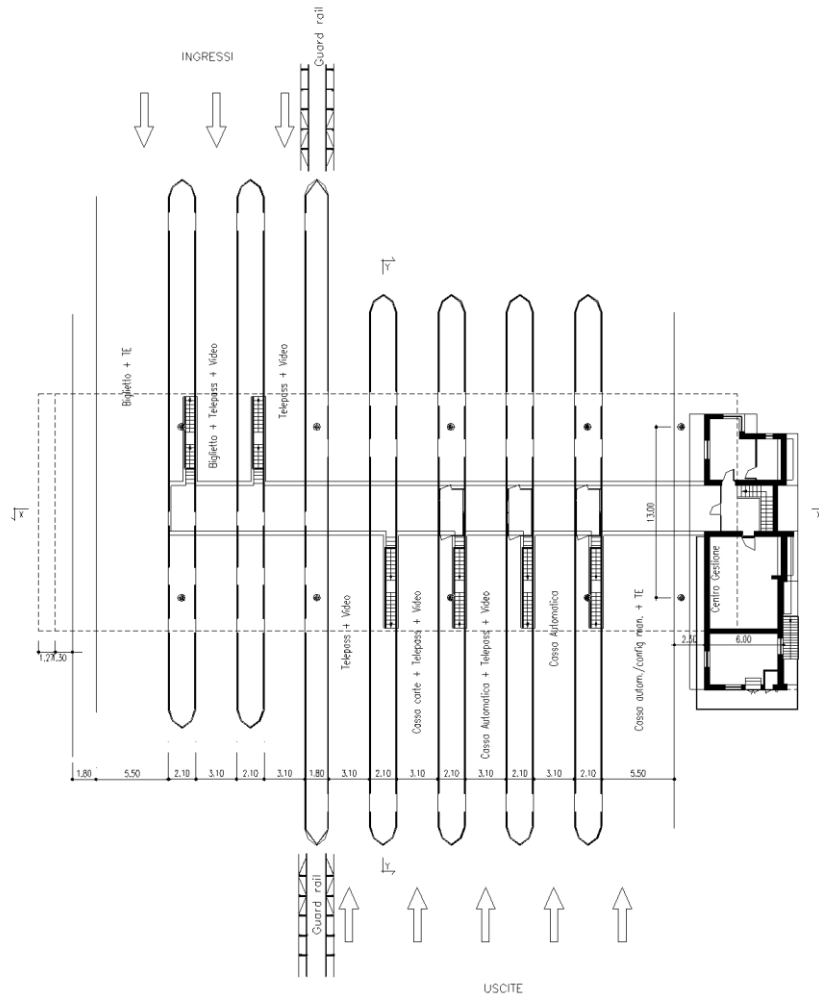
Planimetria Sistemazione Casello Ingresso/Uscita
